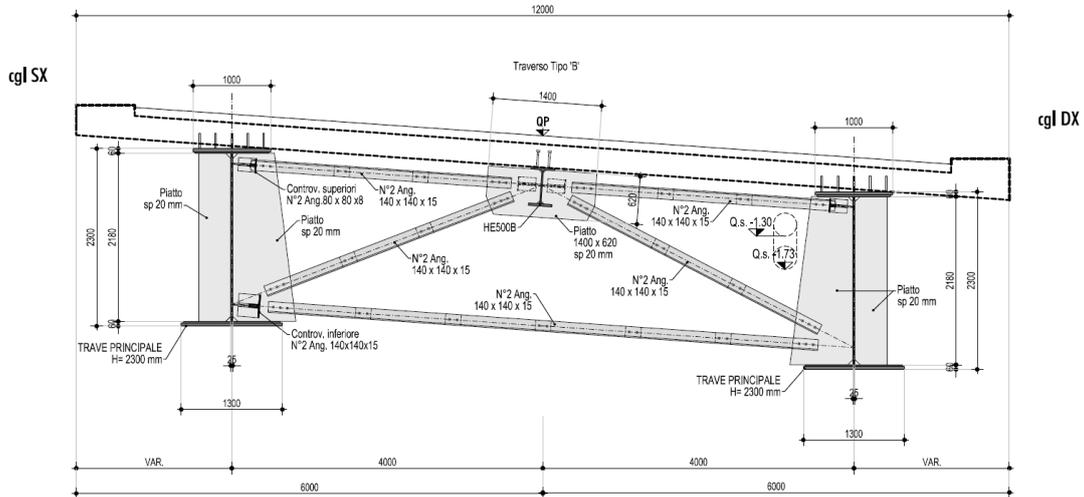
SEZIONE TRASVERSALE IMPALCATO IN CAMPATA
